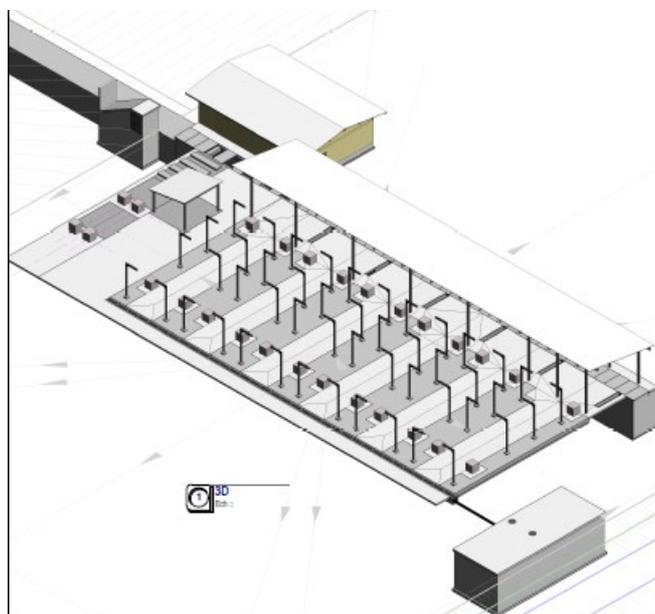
Vue 3D du stockage LOX (plan 3826-XD-1739-0005-RDP-C)
